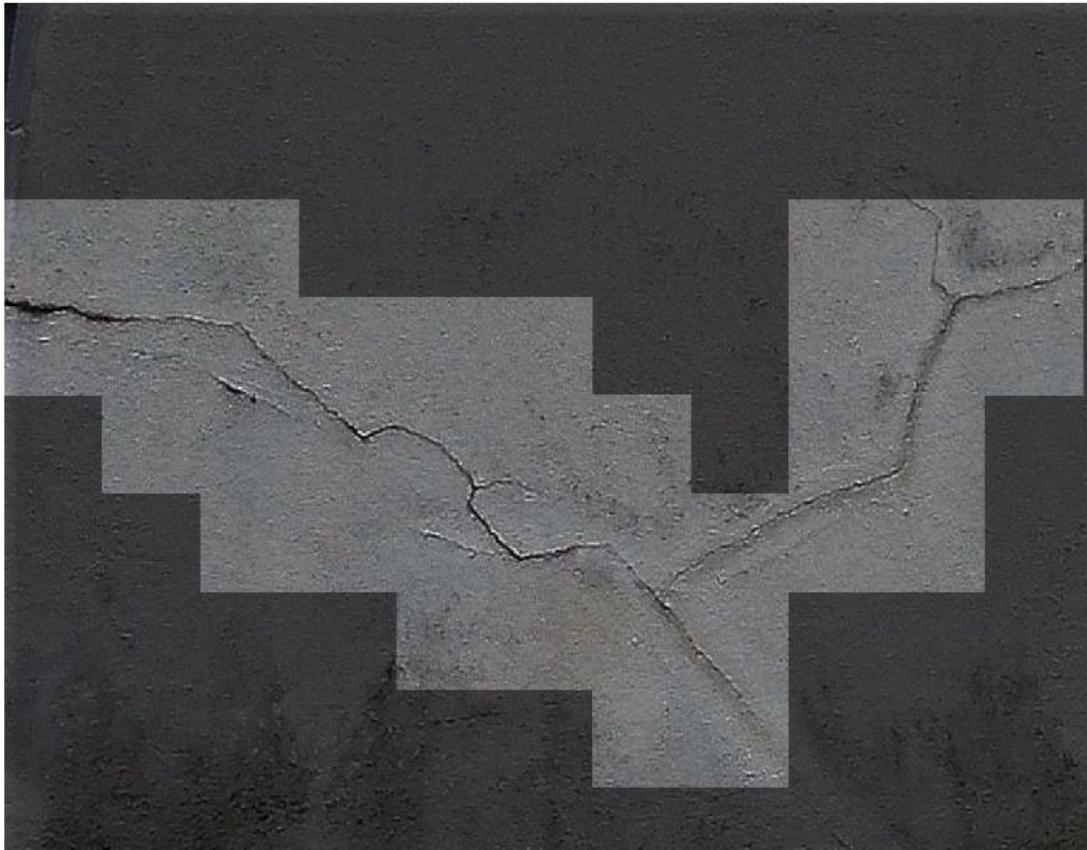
Detecção Fissura Z.F.13
